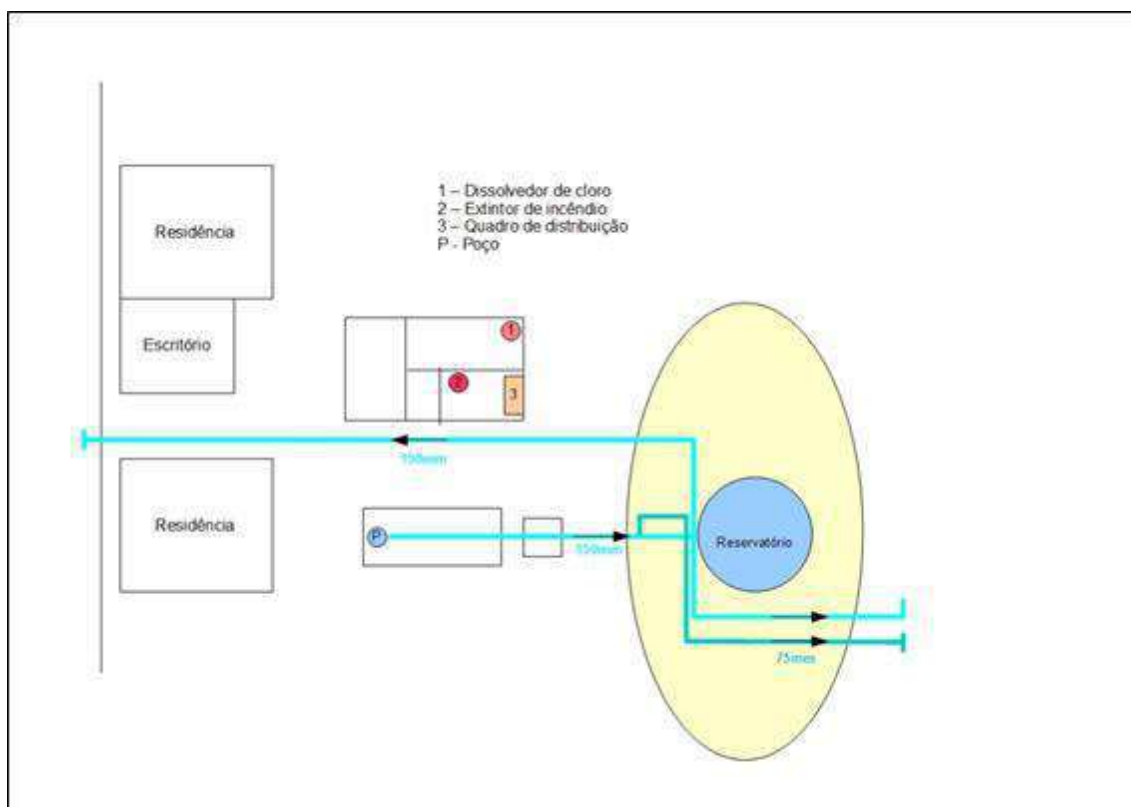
5 – Layout da área onde se encontra instalado o poço P1A.
